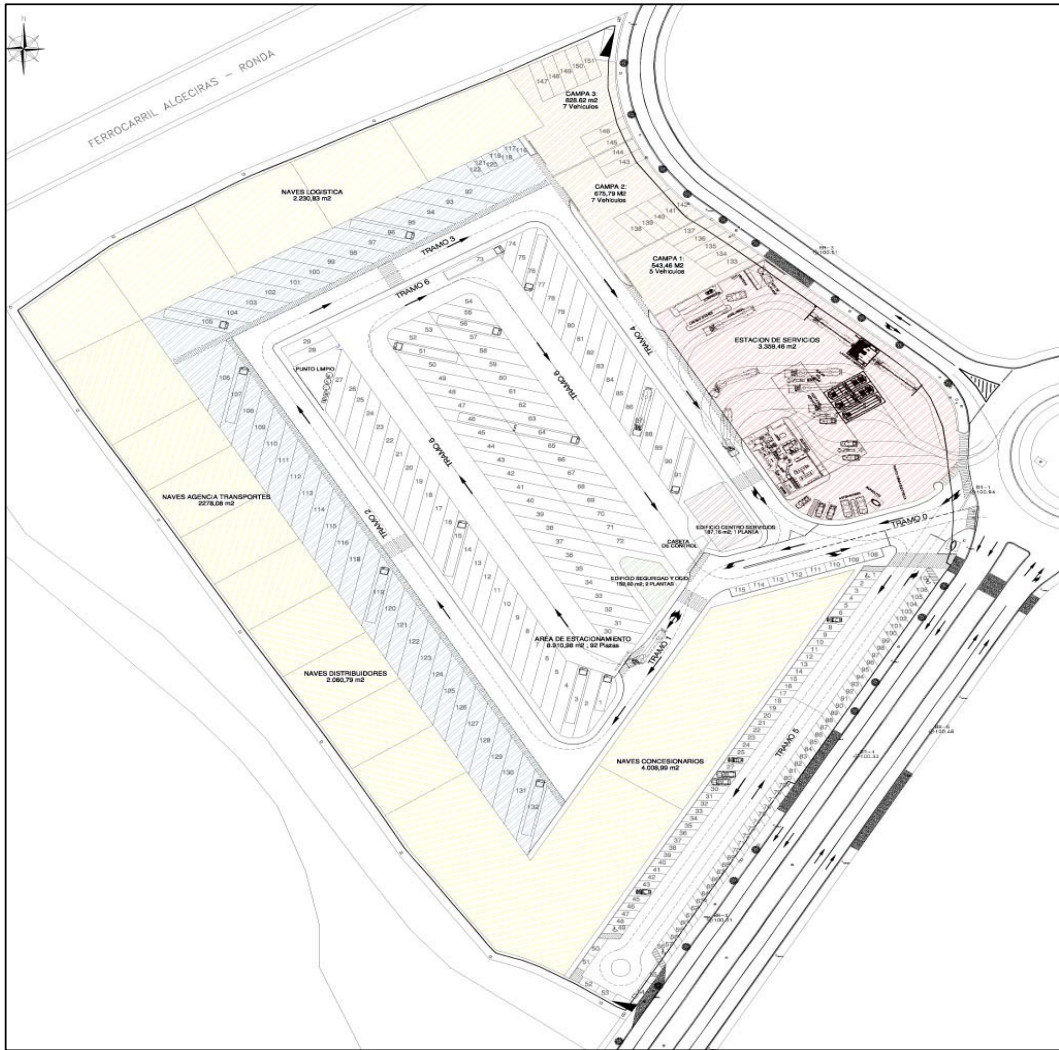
E.D. CSC: Plano de Ordenación Parcela.
